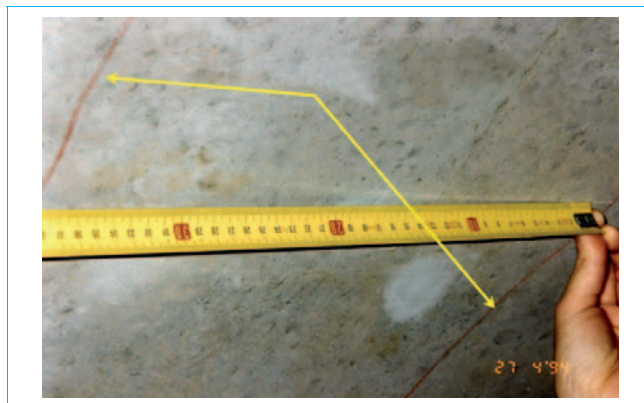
Fissures dans une dalle d'un pont mixte acier-béton
